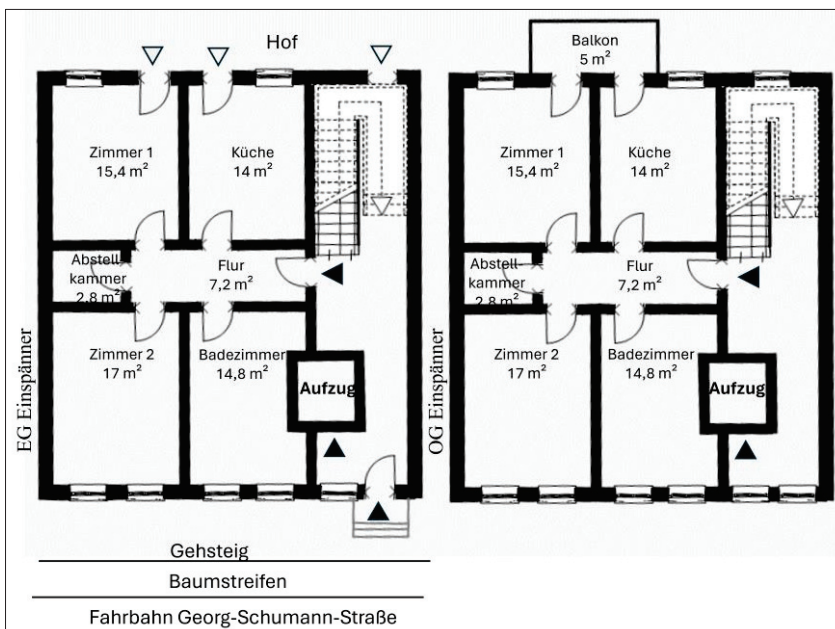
Grundriss der Zweizimmerwohnungen im Einspänner. Quelle: Eigene Darstellung.
